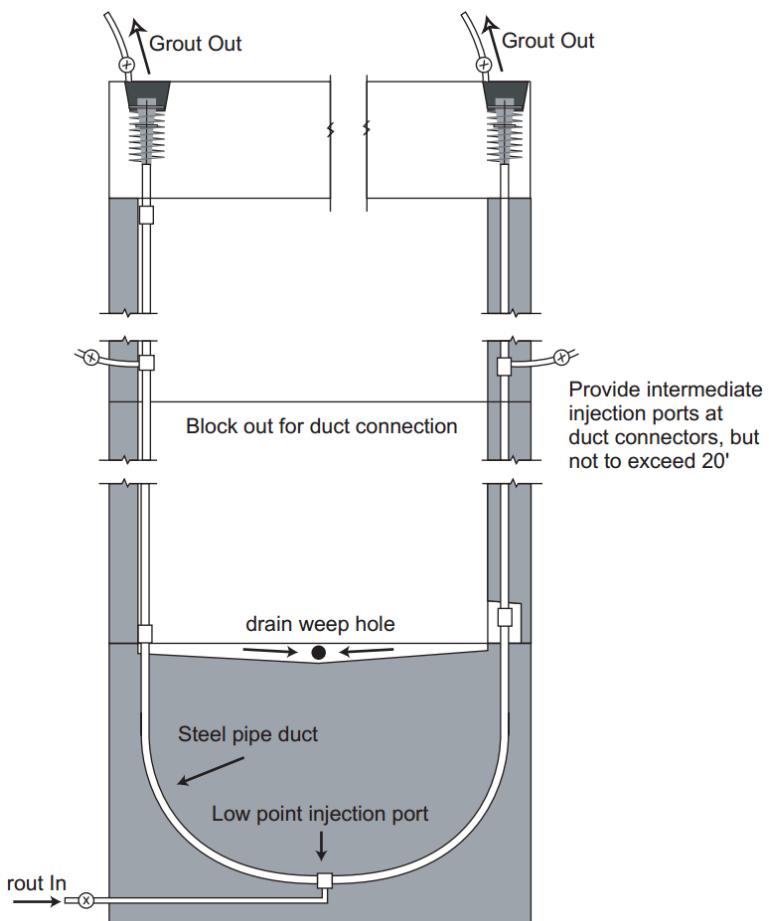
Detalles de grouting y anclaje para tendones verticales en pilares.
